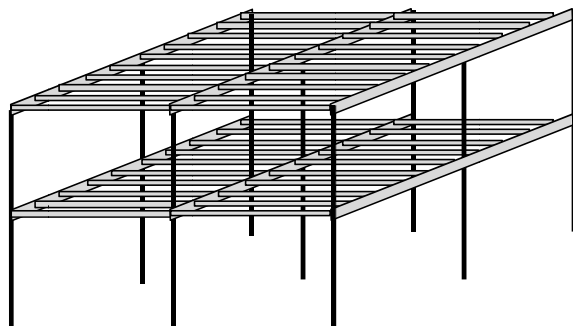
Costruzione di un edificio con griglia di pilastri e travi inflesse
